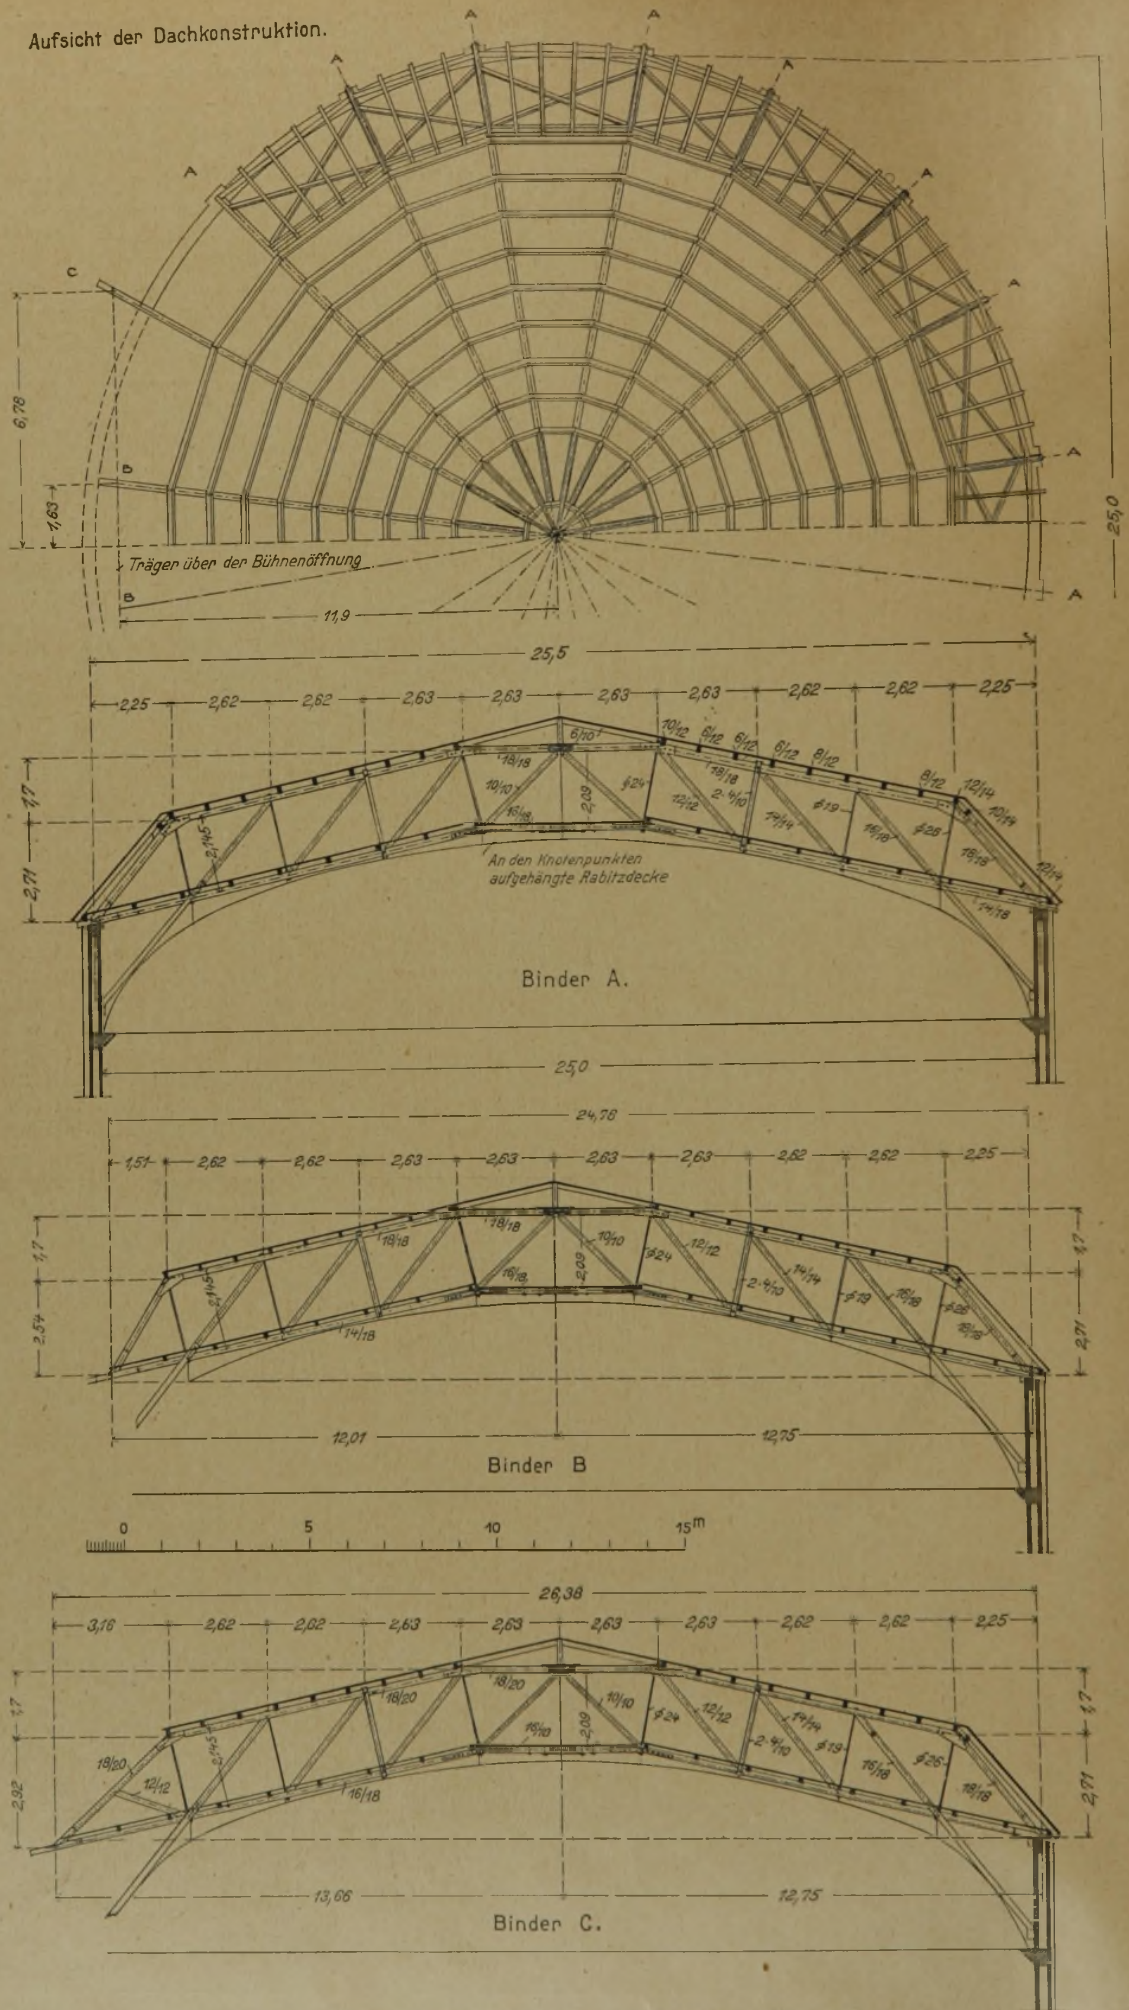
Anordnung und Ausbildung der Dachbinder im Theater zu Riga.
